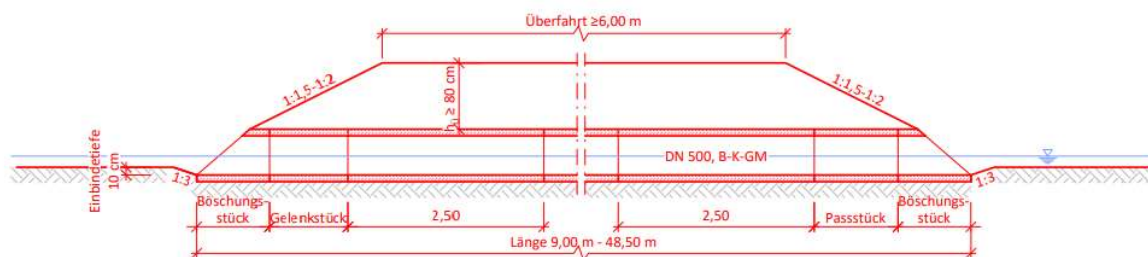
Längsschnitt der Teilverrohrung (Beton Rohrdurchlässe)
